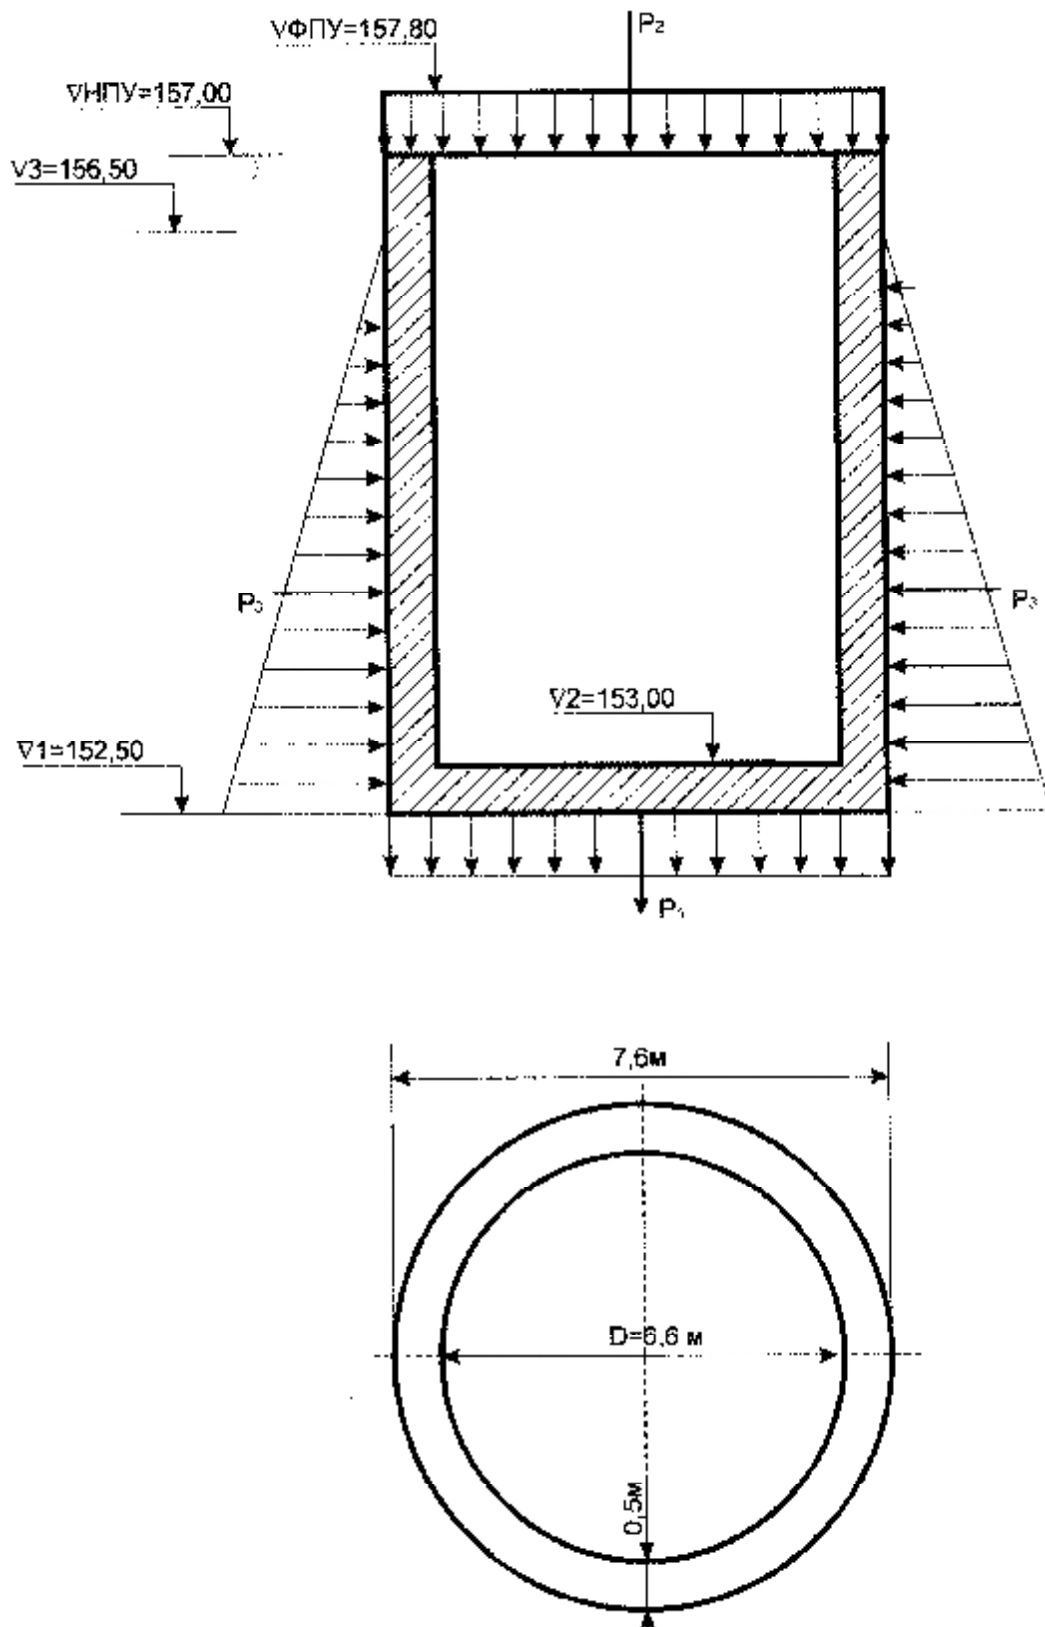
Схема ковша к статическому расчету ковшового водосброса
